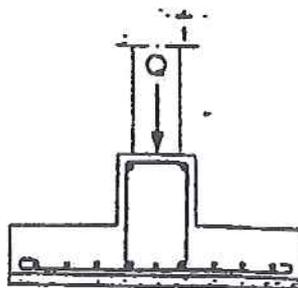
Semelle continue élargie en béton armé « profil en T renversé » avec double réseau d'armatures.
